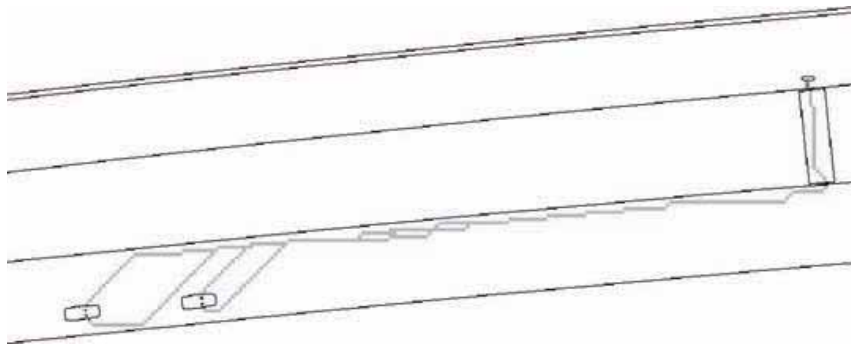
Detalle camino evacuación en la galería del pk 113+240
